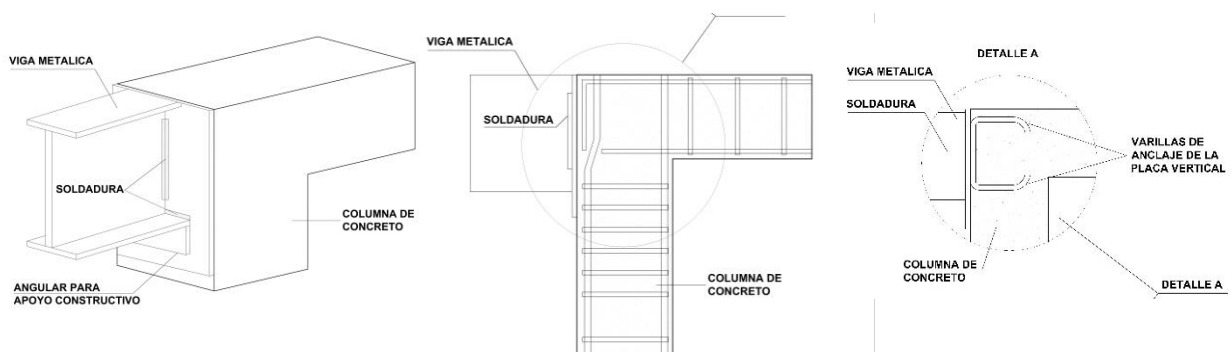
Detalles Constructivos – Anclaje Acero en Concreto
